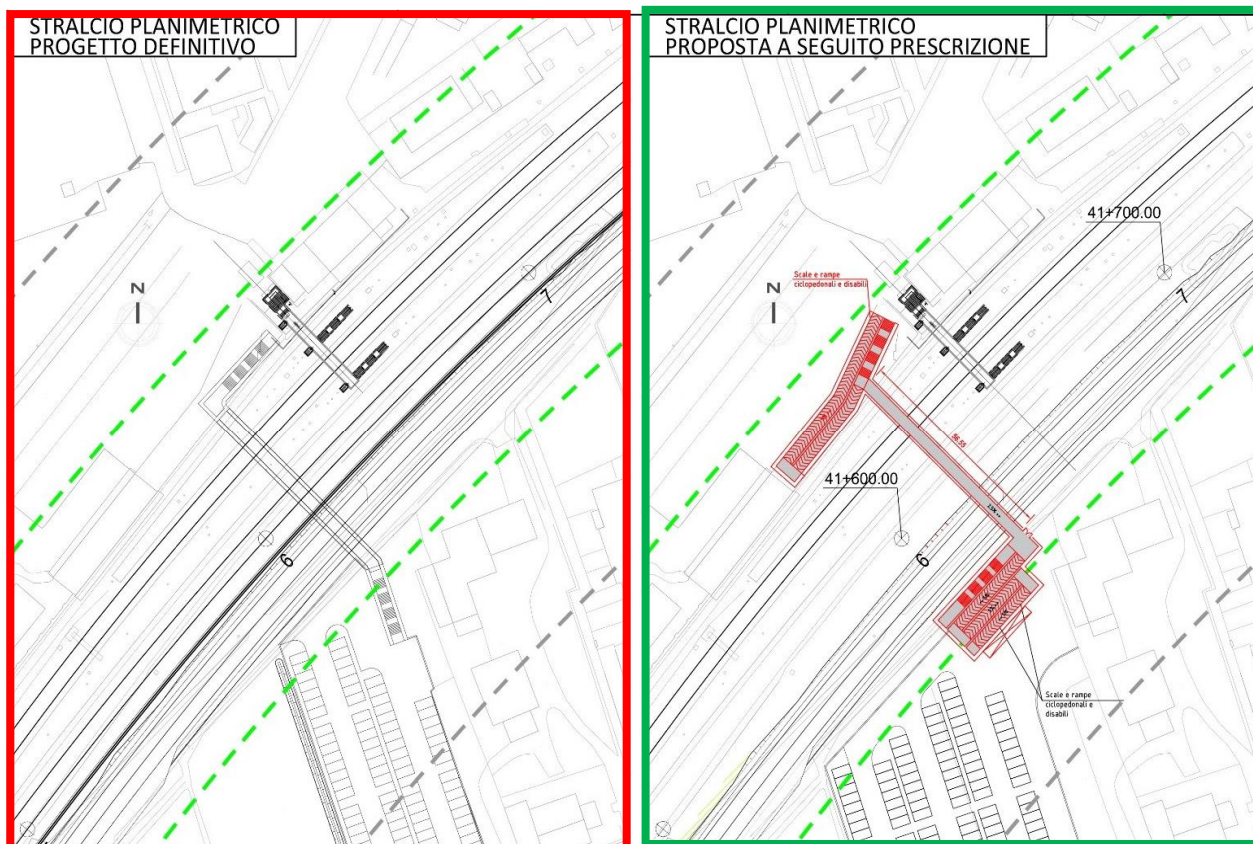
Confronto planimetria PD (rosso) PE (verde)
